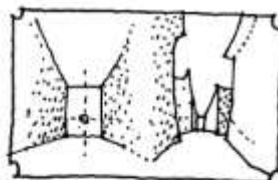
Dwa charakterystyczne widoki wnętrza o planie kwadratowym
